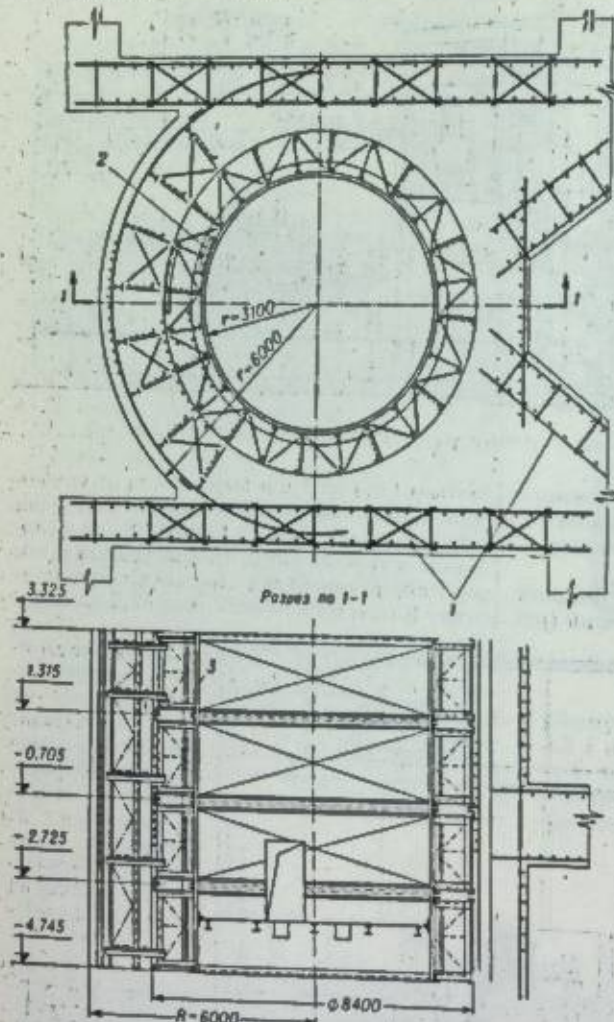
Бетонная шахта для установки реактора (армирование): 1 — фермопакеты стен из гибкой арматуры; 2 — жесткие кольцевые фермы с дополнительной гибкой арматурой, воспринимающие избыточное давление и усилия от перепада температур; 3 — облицовка из углеродистой стали.
